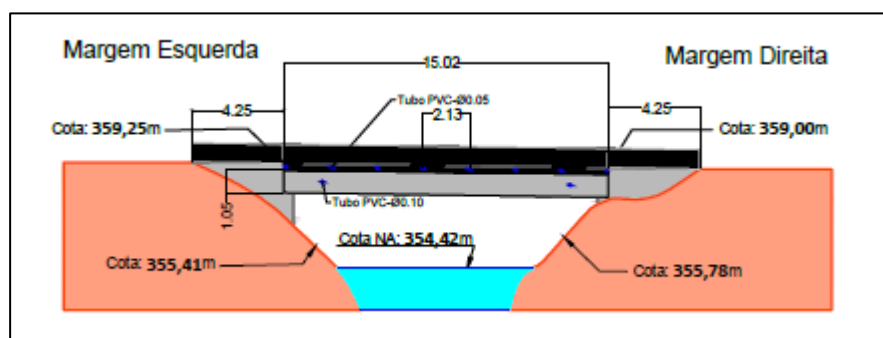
Levantamento Ponte Estrada Candido Mota 030
